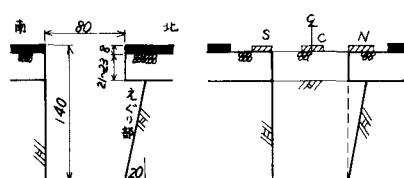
掘削断面図(cm) 図2-3 平板載荷試験位置図
